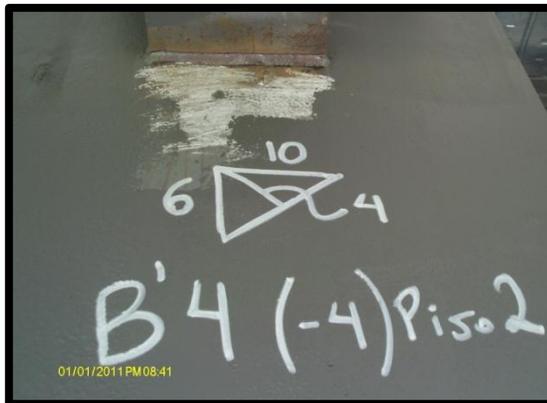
Triángulo con dimensiones de soldadura
